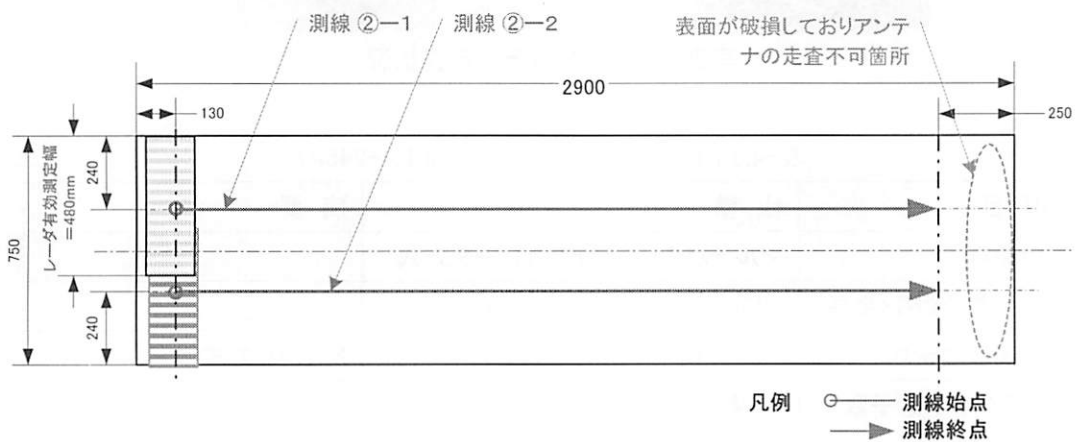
供試体②の平面図とMPLAレーダアンテナ走査位置
